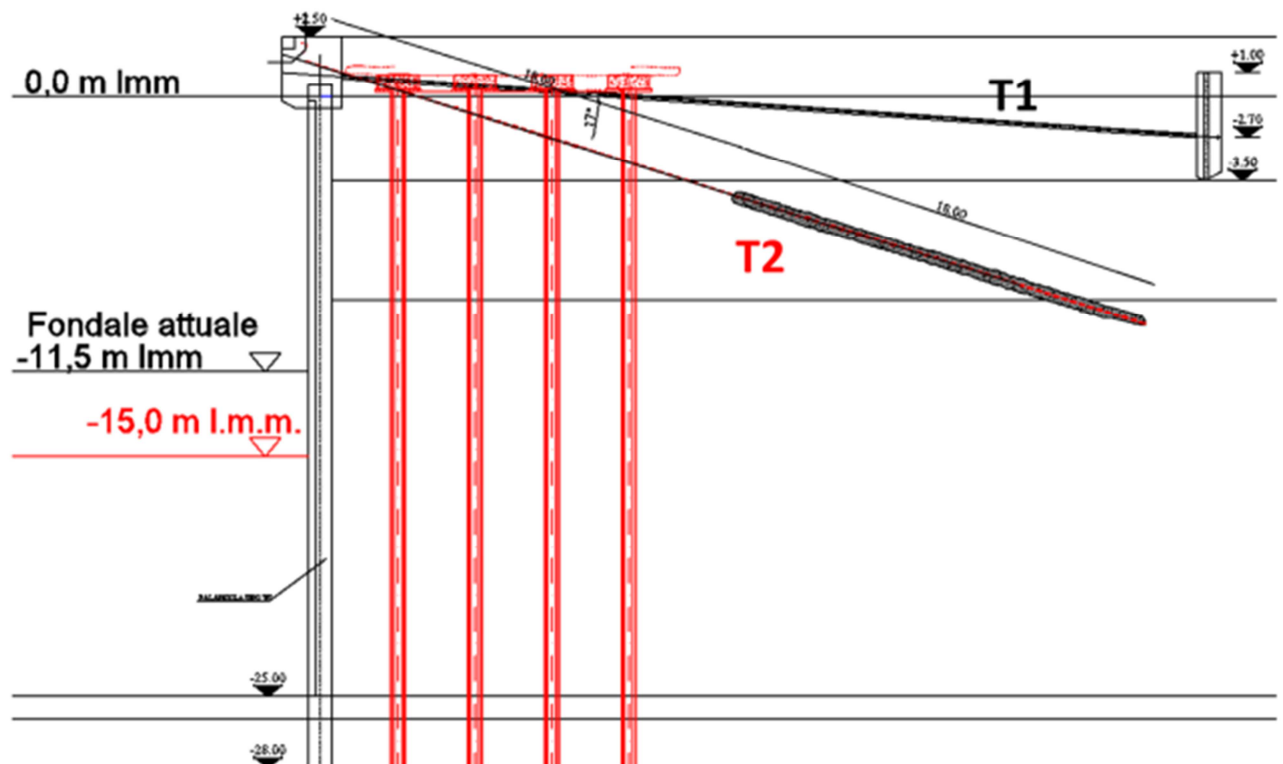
Sezione tipo intervento di adeguamento con indicazione dei tiranti di ancoraggio
